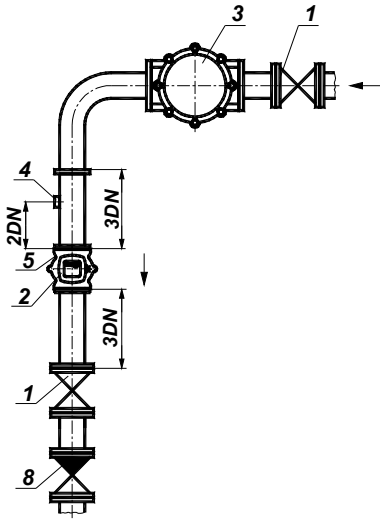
Схема монтажу лічильника (безбайпасна) на вертикальному газопроводі
